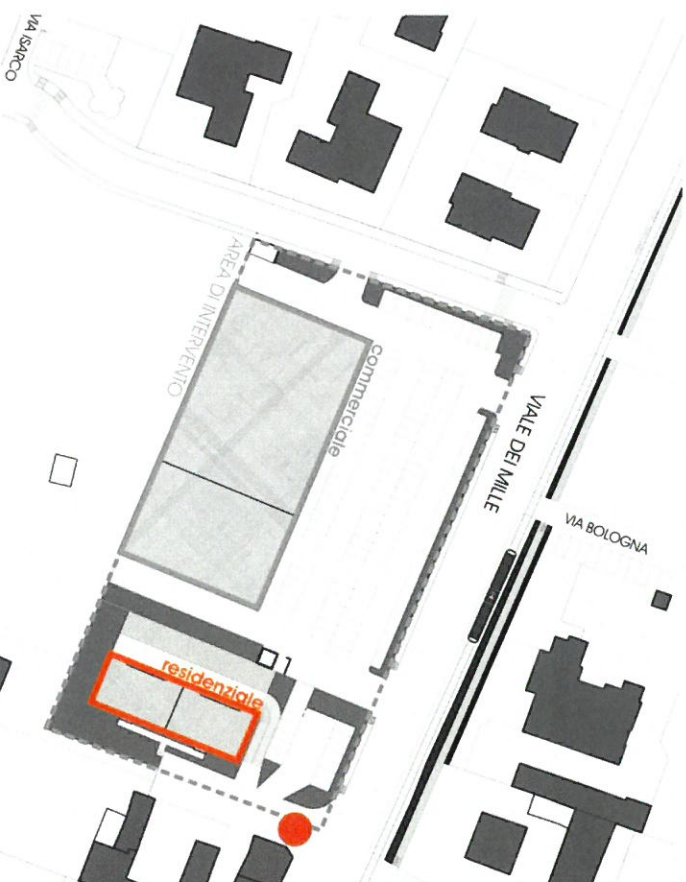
Planimetria di intervento – Accessi veicolari al comparto – funzione residenziale
